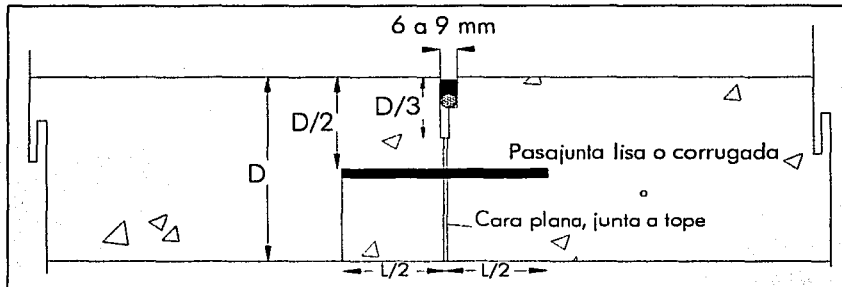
Junta transversal de construcción con pasajunta lisa o corrugada.
